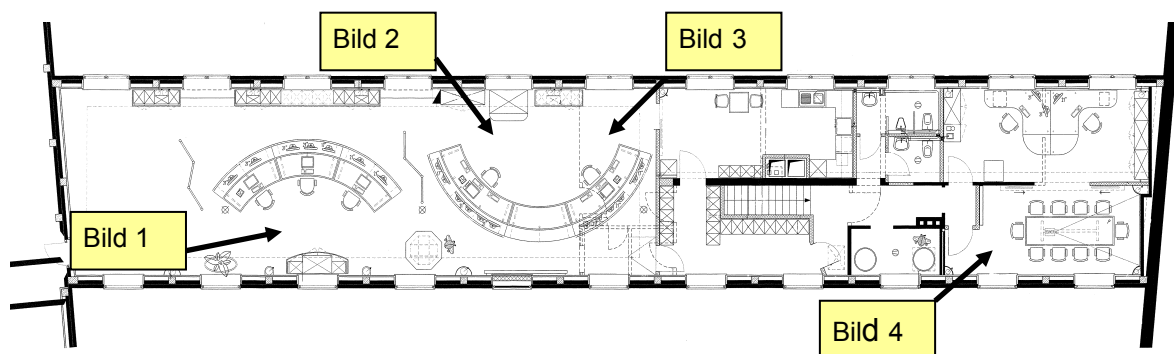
Grundriss Verkehrszentrale Bremen
